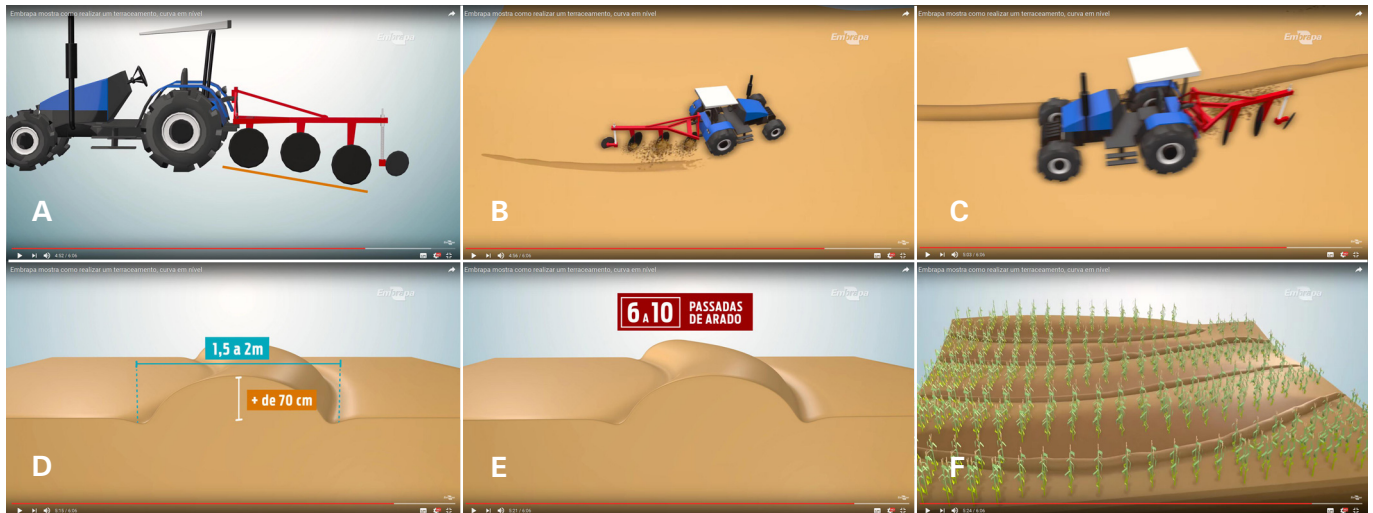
Construção do terraço com trator de 75 cavalos e arado de três discos: (A) posicionamento do arado no trator; (B) primeira passada do arado jogando a terra de cima para baixo; (C) segunda passada do arado jogando a terra de baixo para cima; (D e E) altura e largura do terraço entre seis a dez passadas de arado e; (F) plantio de milho em nível acompanhando o terraço.
